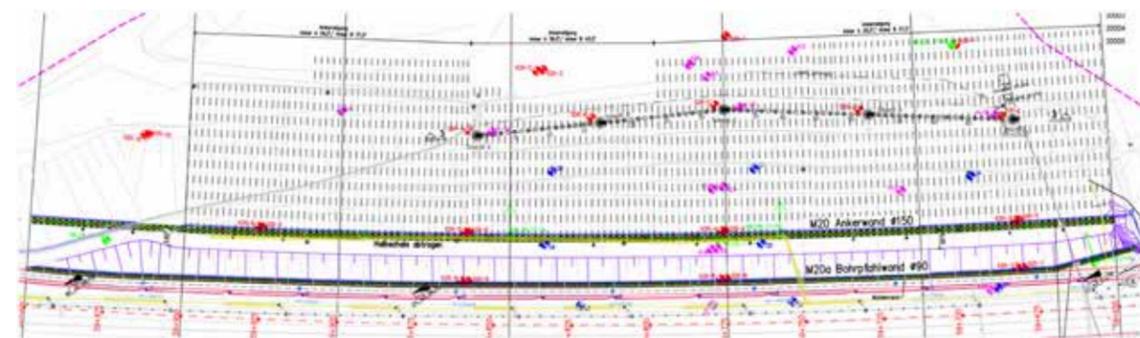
Übersichtslageplan Einschnitt E8 mit geankerte Bohrfahlwand DN1.500 (im Bild oben) und mit Bohrfahlwand DN900 (im Bild unten)
